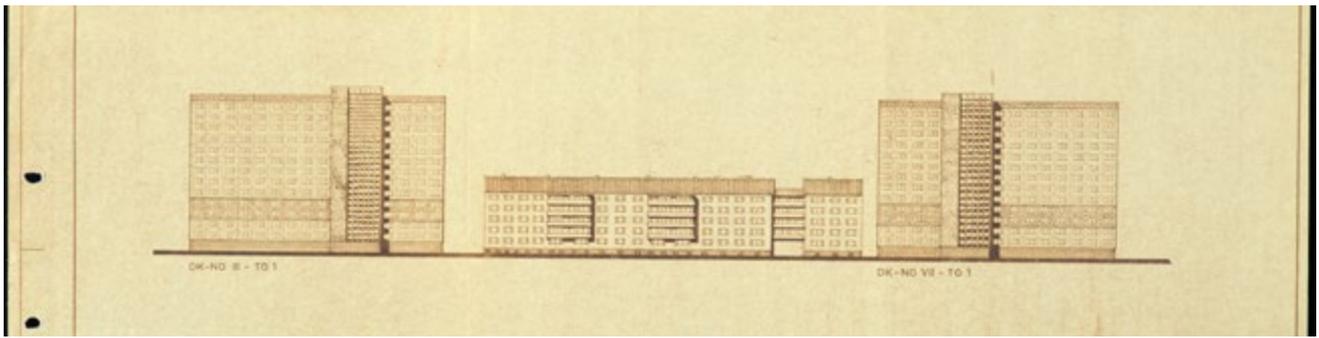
Entwurfszeichnung Neubauten Frankfurter Allee, Ausschnitt (SHB, 1981) [BStU]
